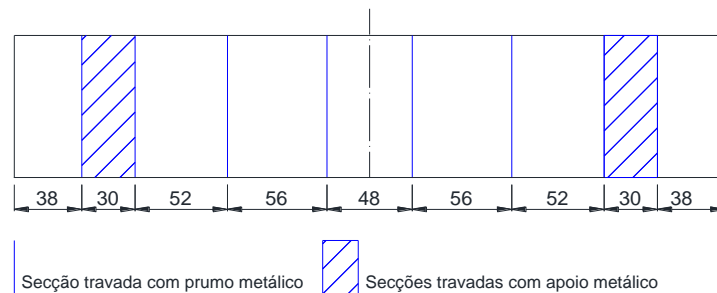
Disposição dos travamentos laterais na viga (em cm)
